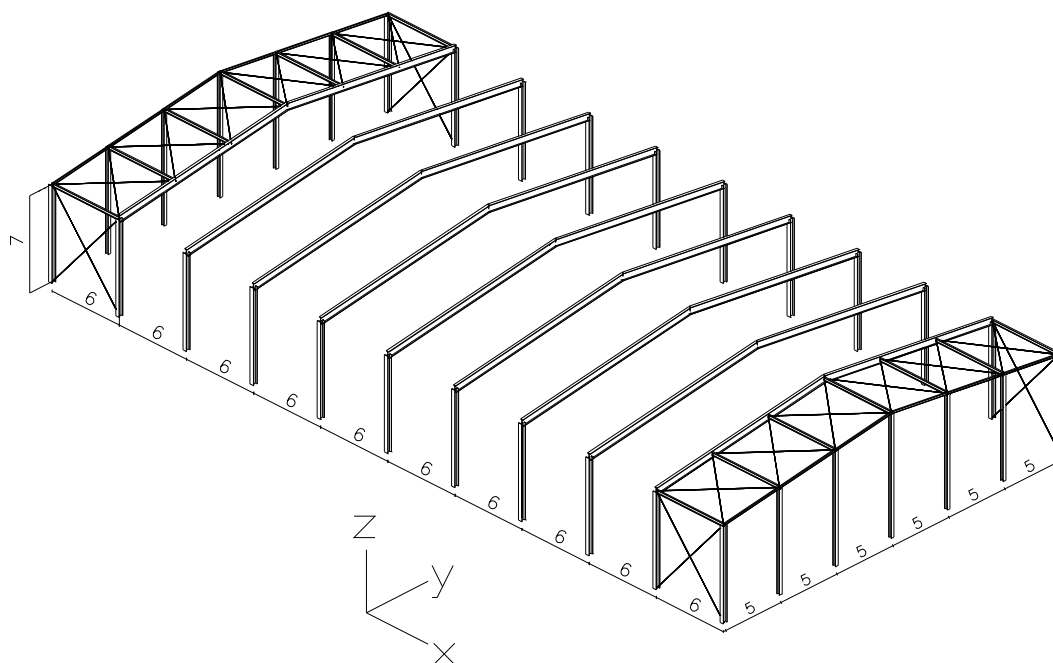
Pavilhão industrial, vão de 30.00m, pórticos rígidos, pilar e viga em perfil de alma cheia, modelo utilizado
